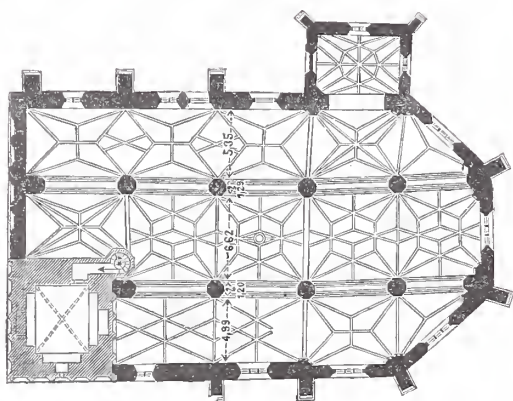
Oberer Grundriss (gegenwärtiger Zustand) mit Weglassung der Emporen.
